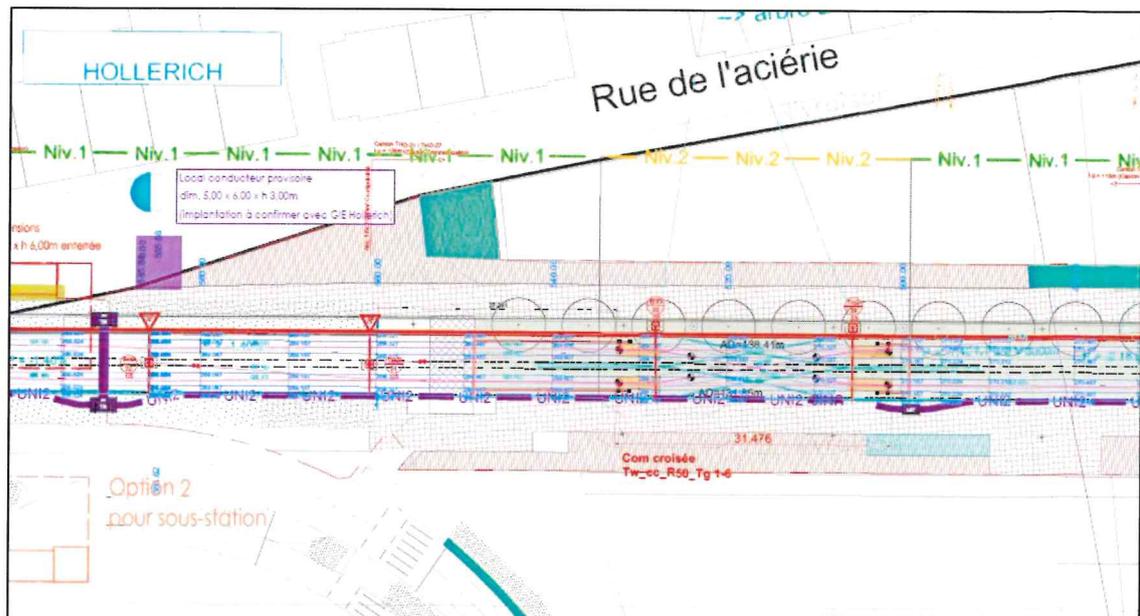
Extrait de plan de voie sur le terminus provisoire Hollerich
